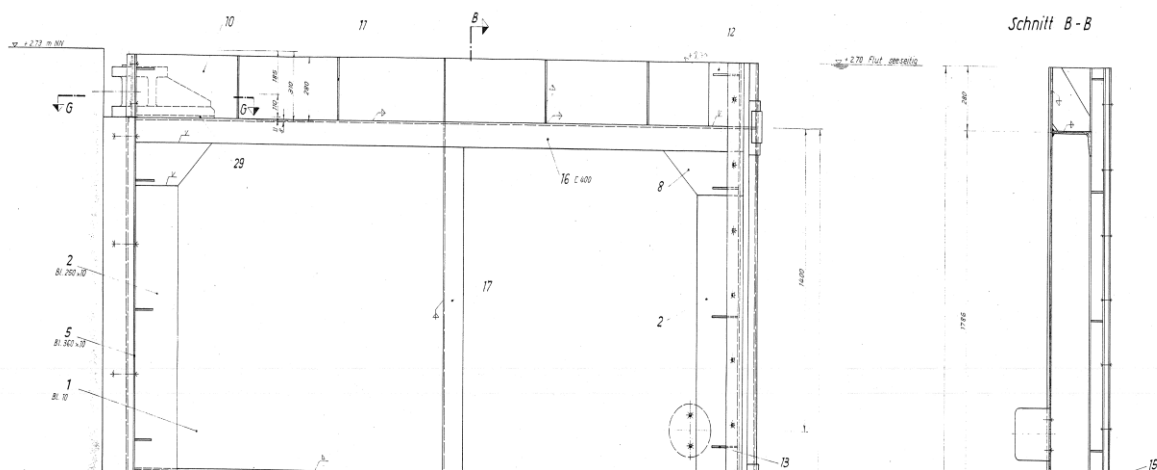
Planausschnitt Bestandsunterlagen Mühlendammschleuse, WSA Stralsund
